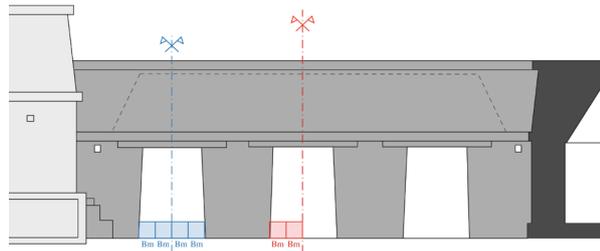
Alzado ideal Cuarto 2 con el posible replanteo.
